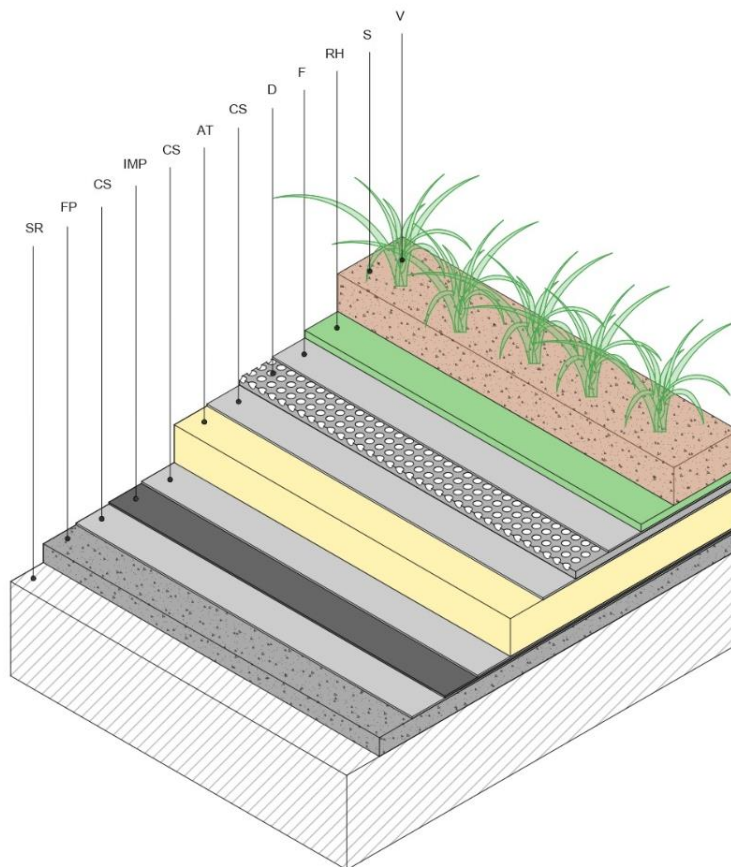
Detalle constructivo colocación capa retenedora en cubierta invertida (1).
